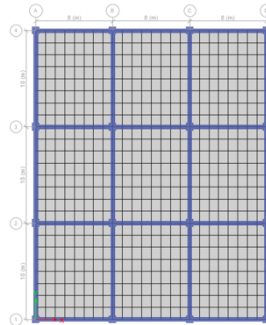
Planta de modelo de 20 niveles orientado en Eje X
